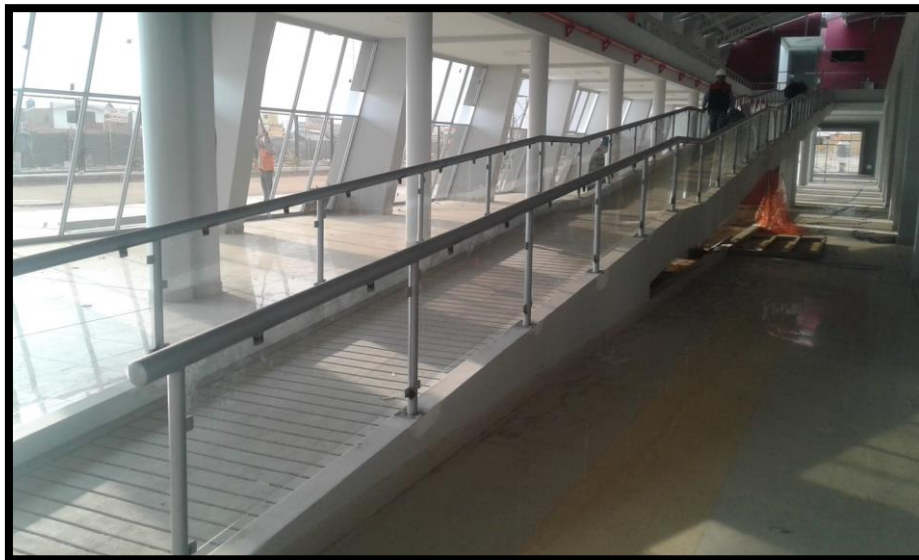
Colocación de vidrio templado en el exterior de 6 mm.
